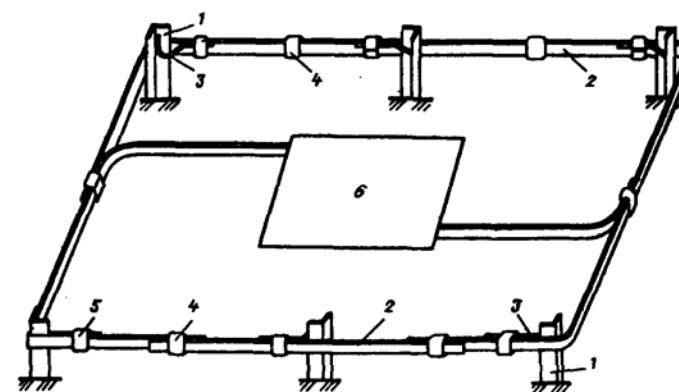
Общий вид заземляющего устройства, выполненного методом термитной сварки:
